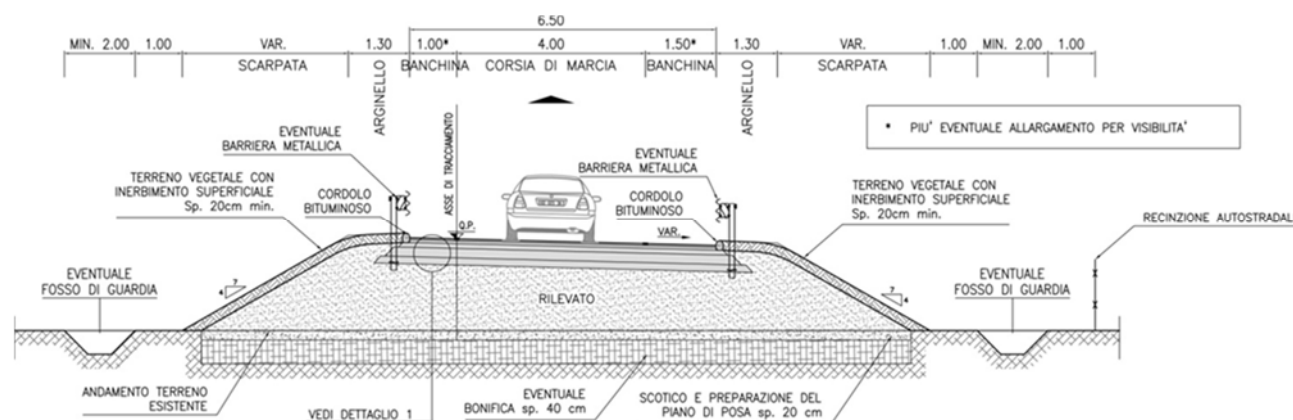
9 Sezione tipo – Rampa di svincolo monodirezionale
